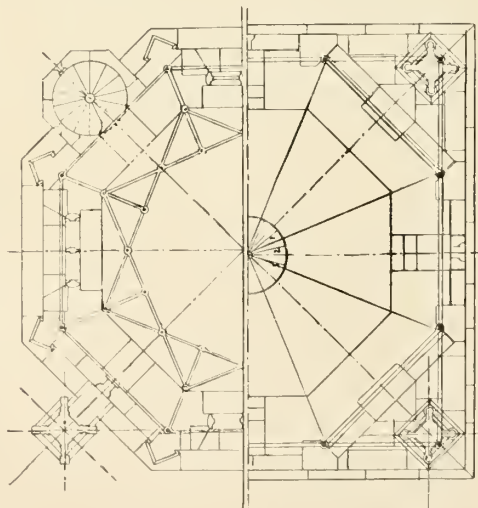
Grundrisse durch die Glockenstube.
